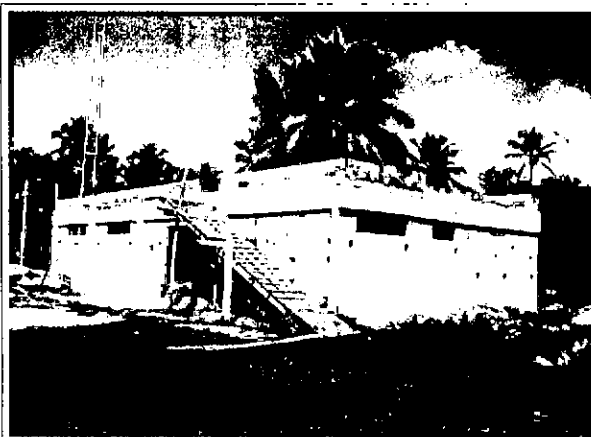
Vista das fachadas posterior e lateral da obra: inexecução da mureta e caixas de ar condicionado não instaladas.
